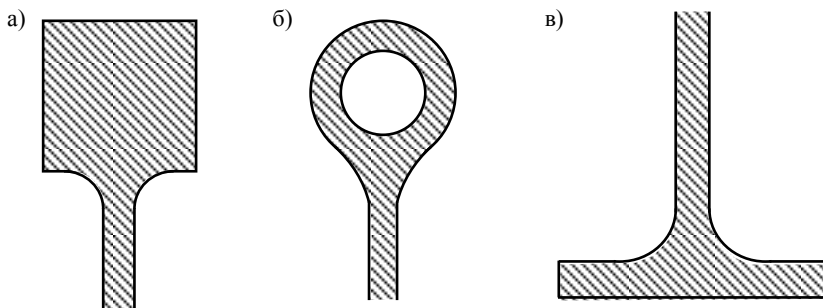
Концевые устройства для разворота автомобилей:
